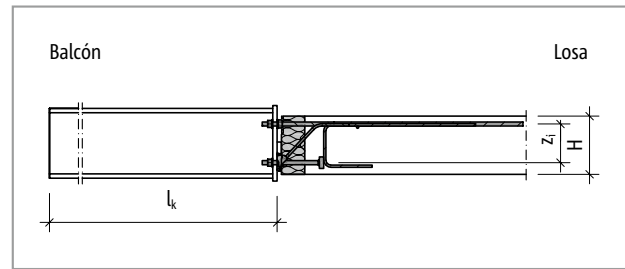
Schöck Isokorb® T tipo SK: Sistema estático; los valores de cálculo se refieren a la longitud del voladizo ilustrada l<sub>k</sub>
